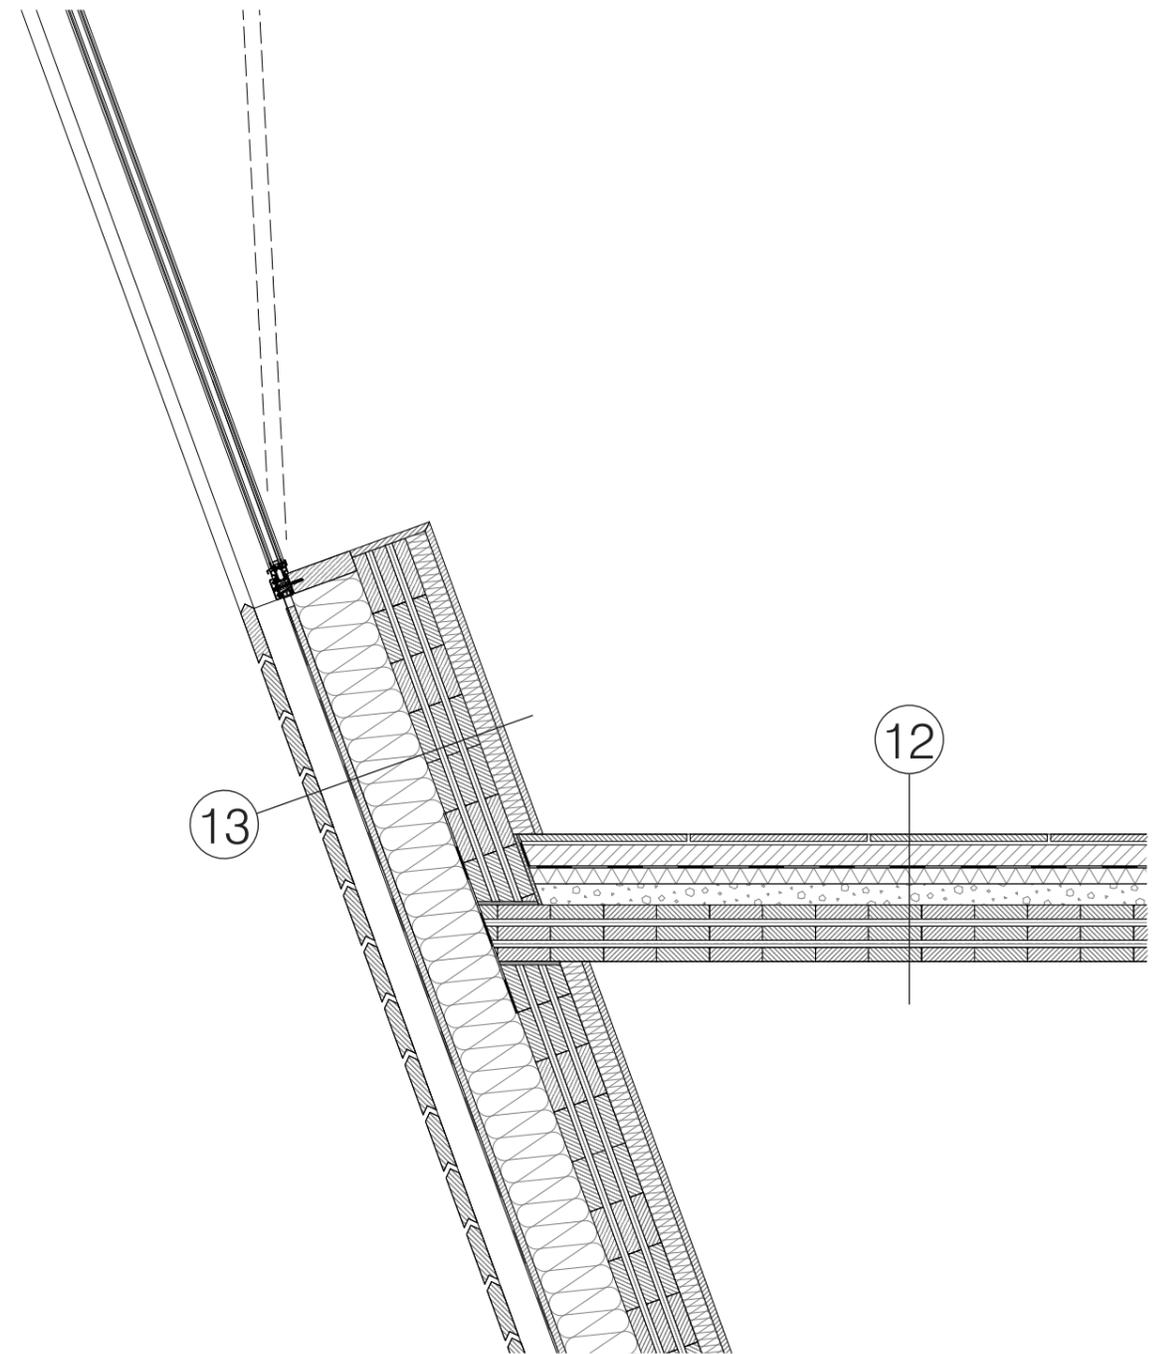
Fassadenschnitt 6 Deckenanschluss 1:20
